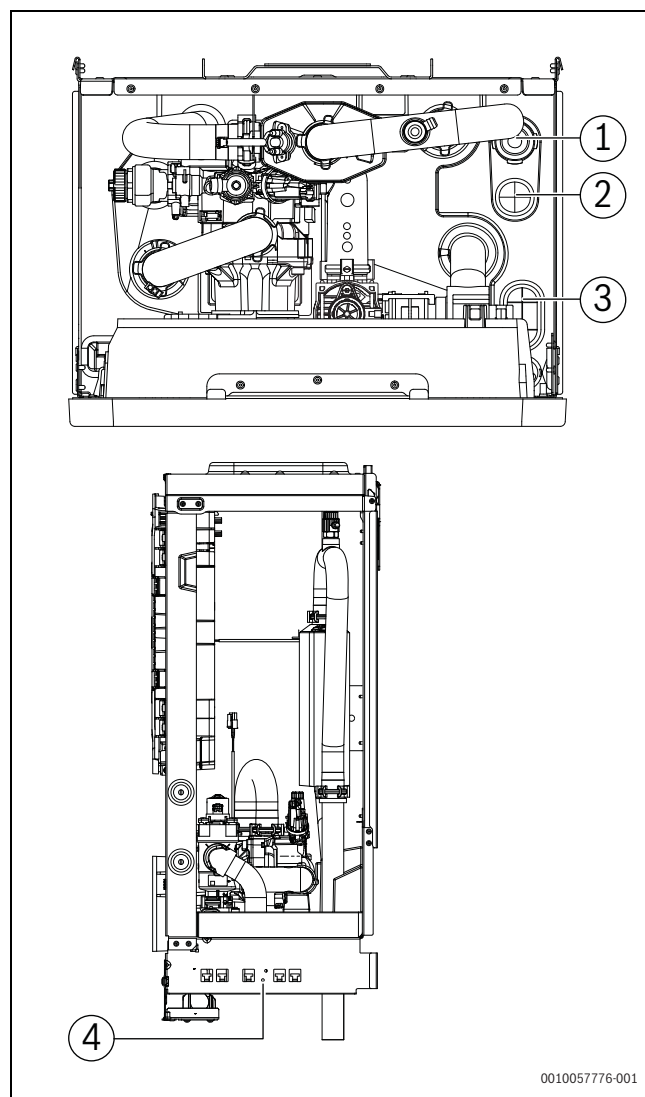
Pressacavi e gommini per l'unità interna (alimentazione principale, accessori e bassa tensione)
